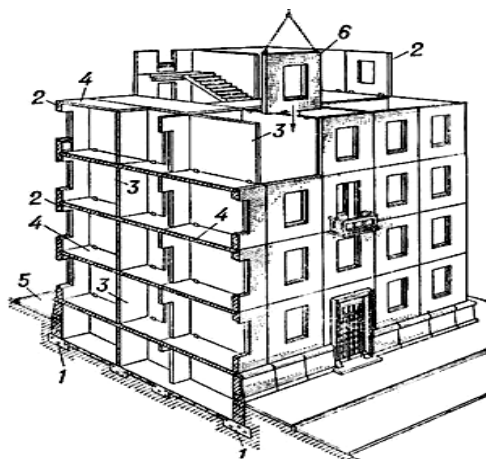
Крупнопанельные конструкции многоэтажного жилого дома: 1 – фундаментная плита; 2 – наружная стеновая панель; 3 – внутренняя стеновая панель; 4 – панель междуэтажного перекрытия; 5 – отсостка; 6 – наружная панель в процессе монтажа
